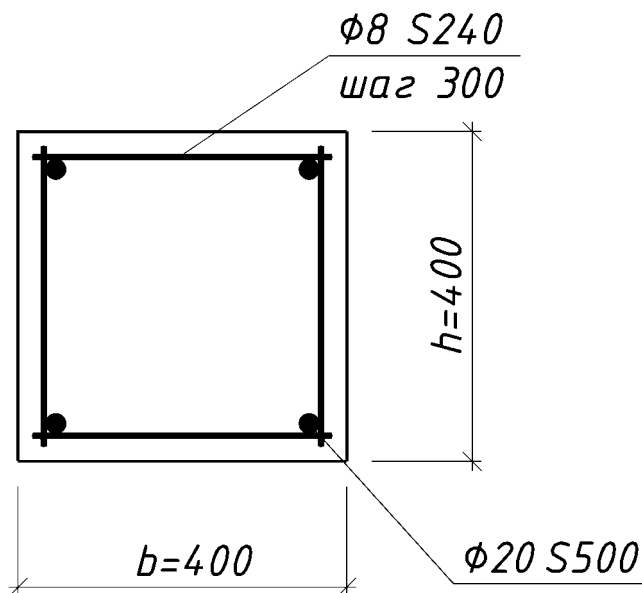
Размещение арматуры в поперечном сечении колонны
